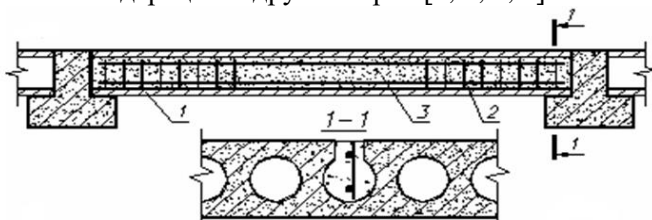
Усиление многопустотных панелей перекрытия установкой дополнительной арматуры: 1 – плита; 2 – сварной каркас; 3 - бетон
